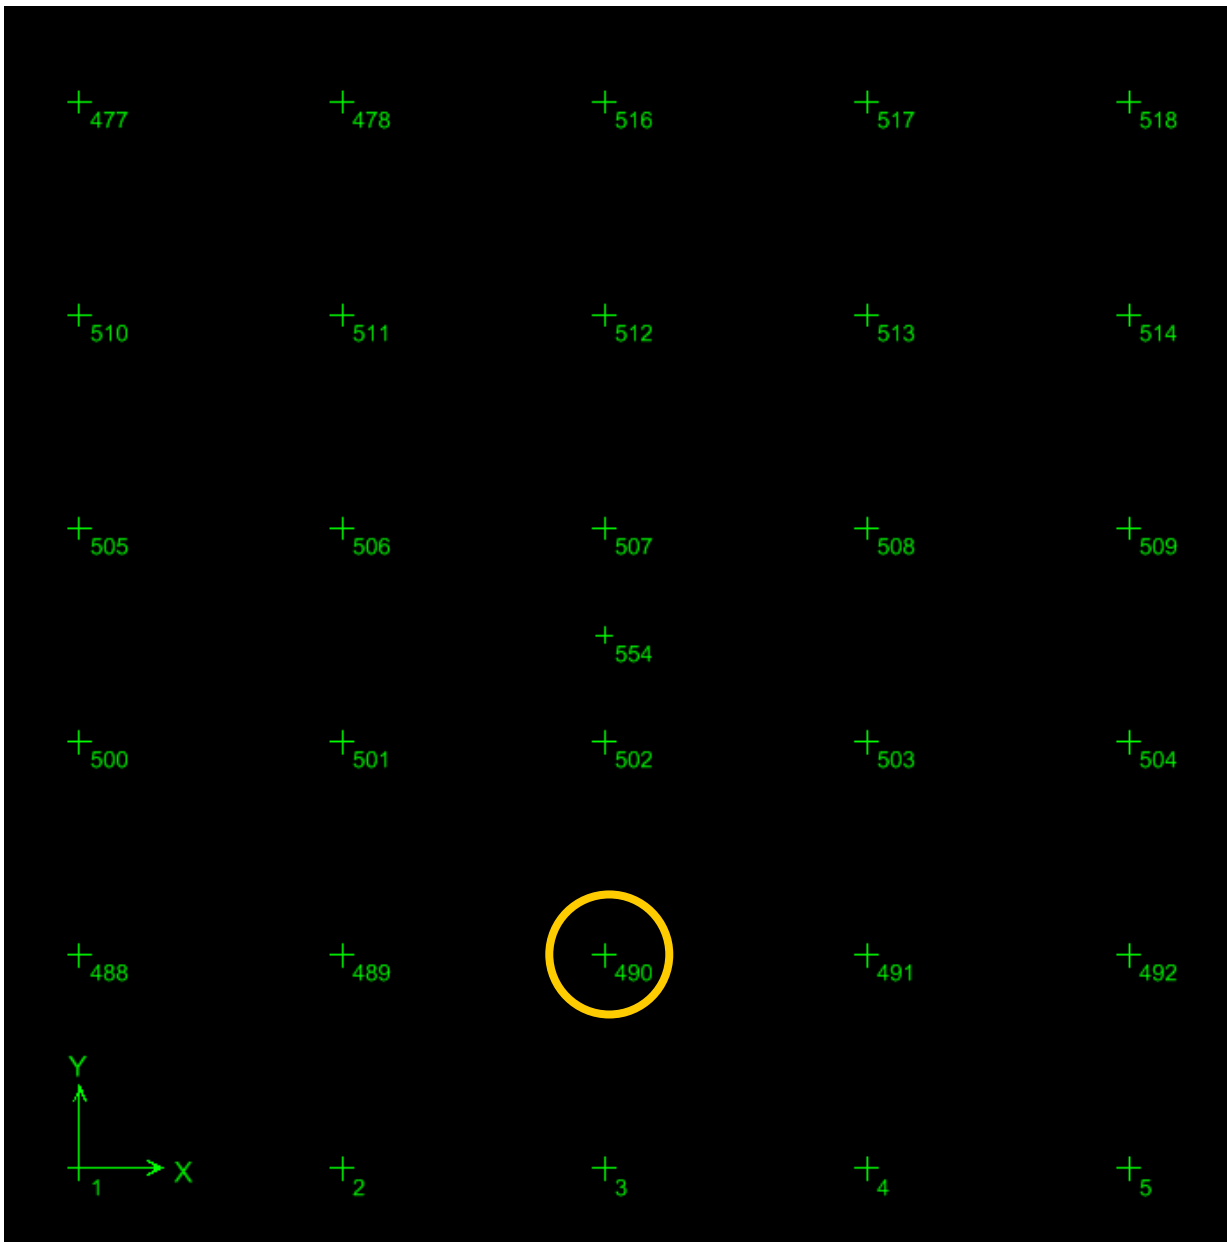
Detalle de la ubicación en planta de las placas aisladas, fuente ETABS vs 9.11 no lineal
